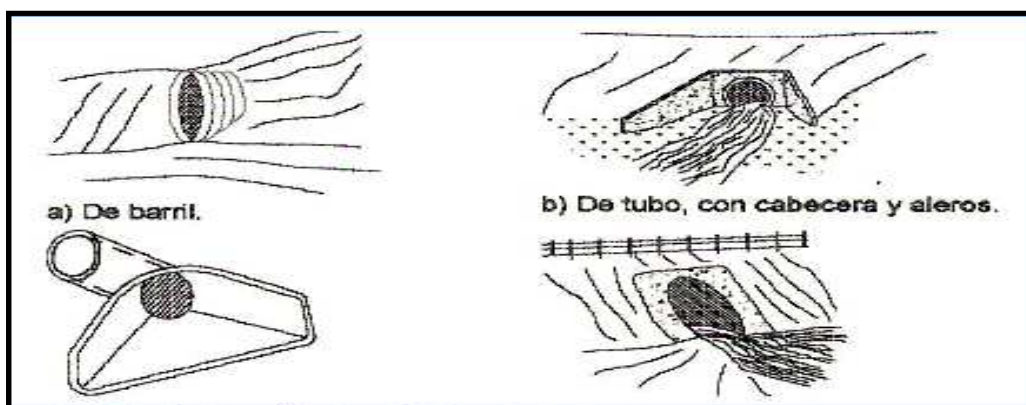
Alcantarillas pluviales. (ASCE, 1992).
